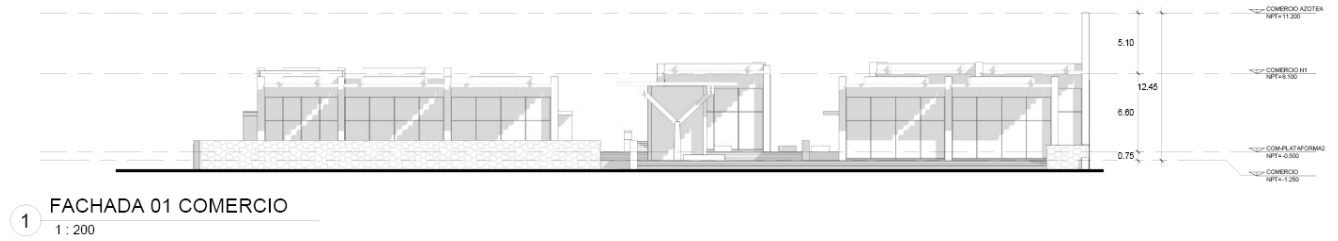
Fachada del Centro Comercial vista desde la vialidad principal.
